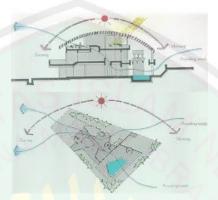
Roof-Roof House Sumber: cultureoffriends.eu
